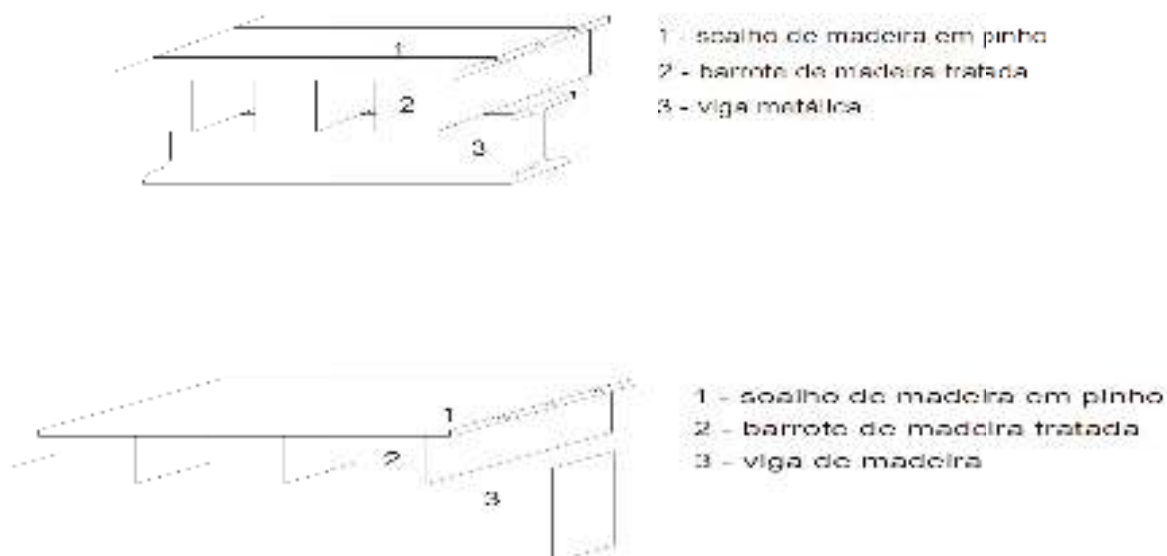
Pavimento de vão múltiplo com viga metálica e de madeira
